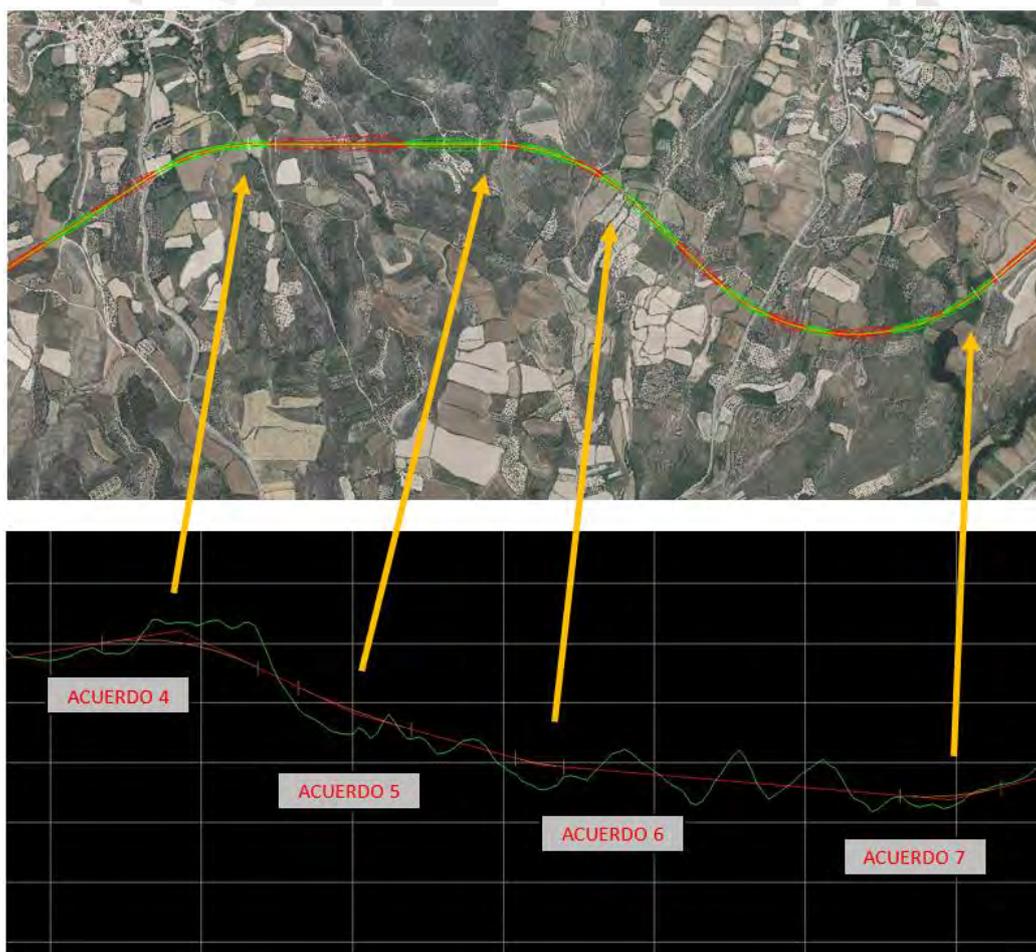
Coordinación Planta-Alzado (Fuente: propia)
